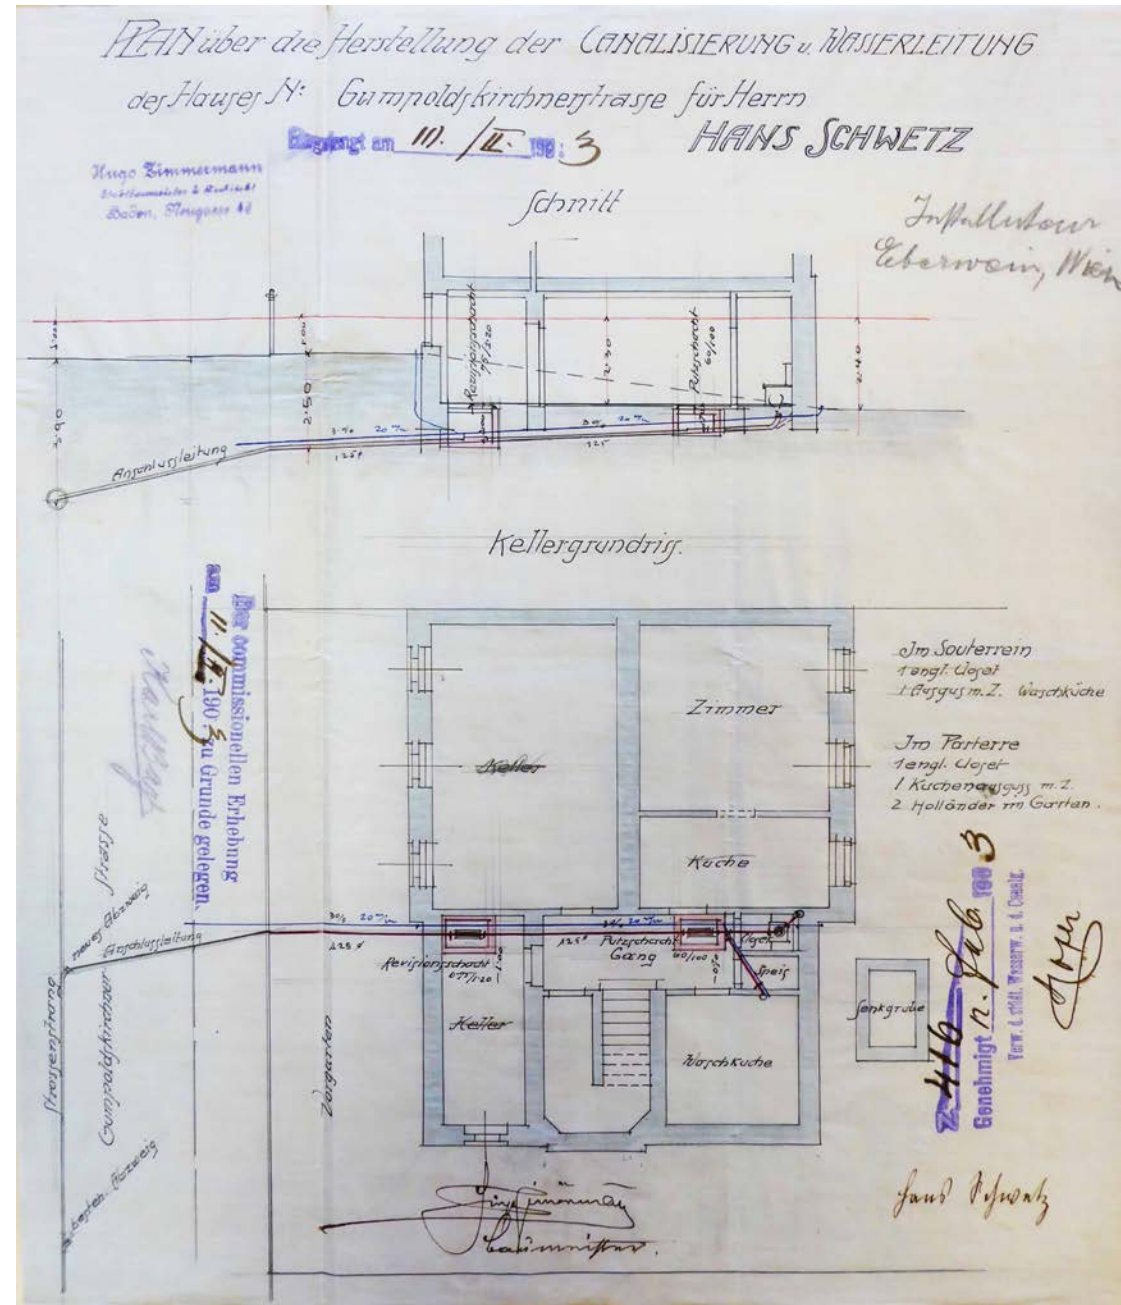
Einreichplan 1903, Anschluss an Kanal und Wasserleitung.
